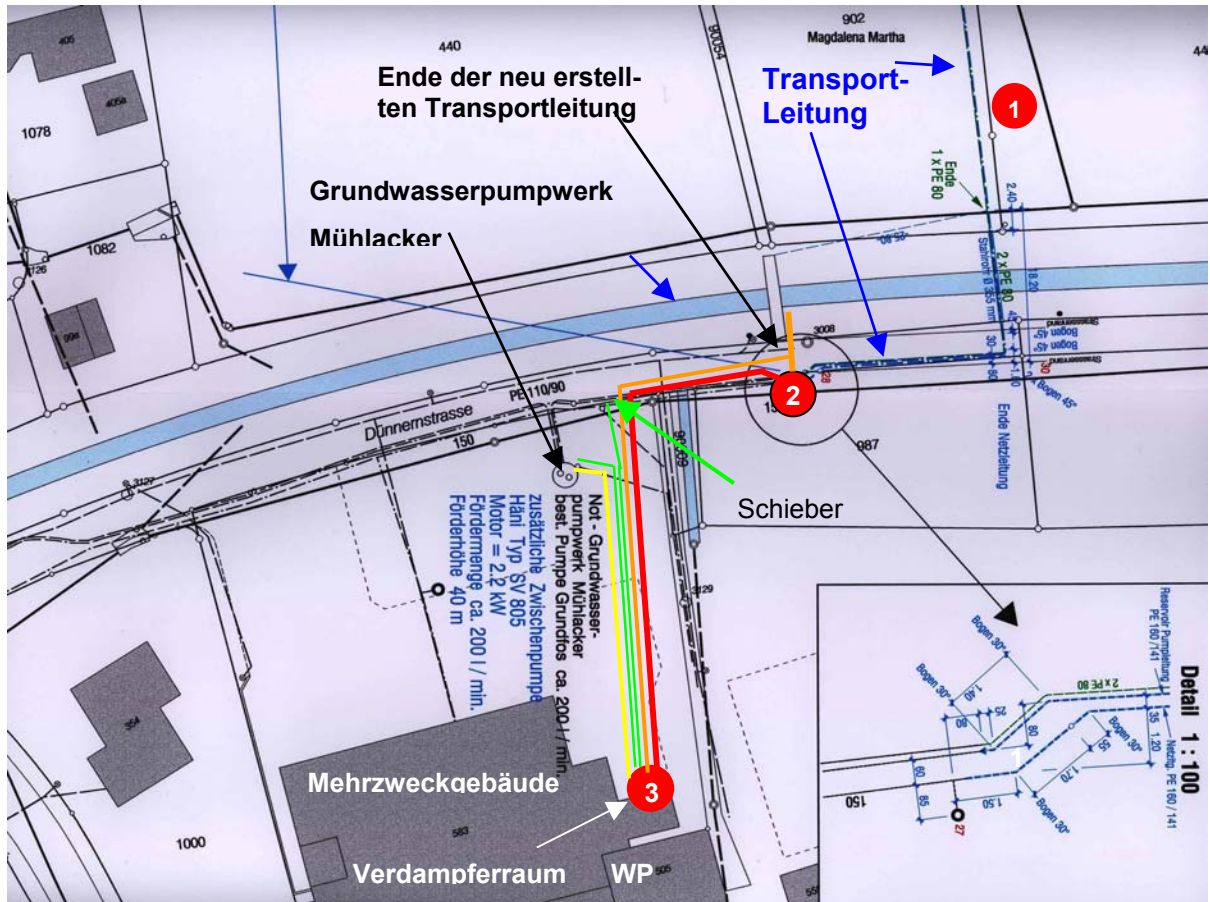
Planausschnitt Turbinenstandorte 1, 2 und 3, Leitungsführung.
